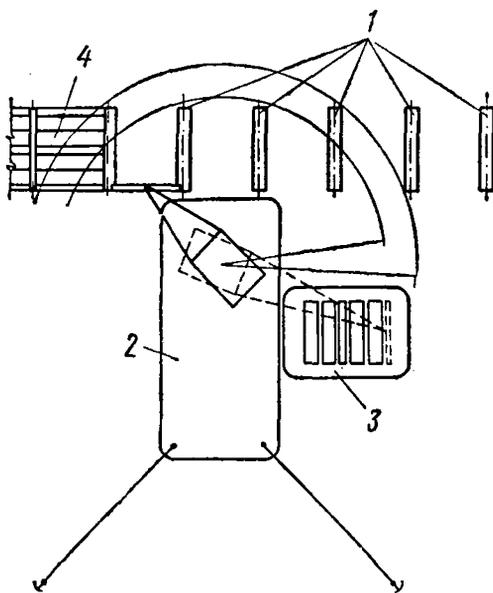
Схема установки бортовых балок и пролетных плит верхнего строения
